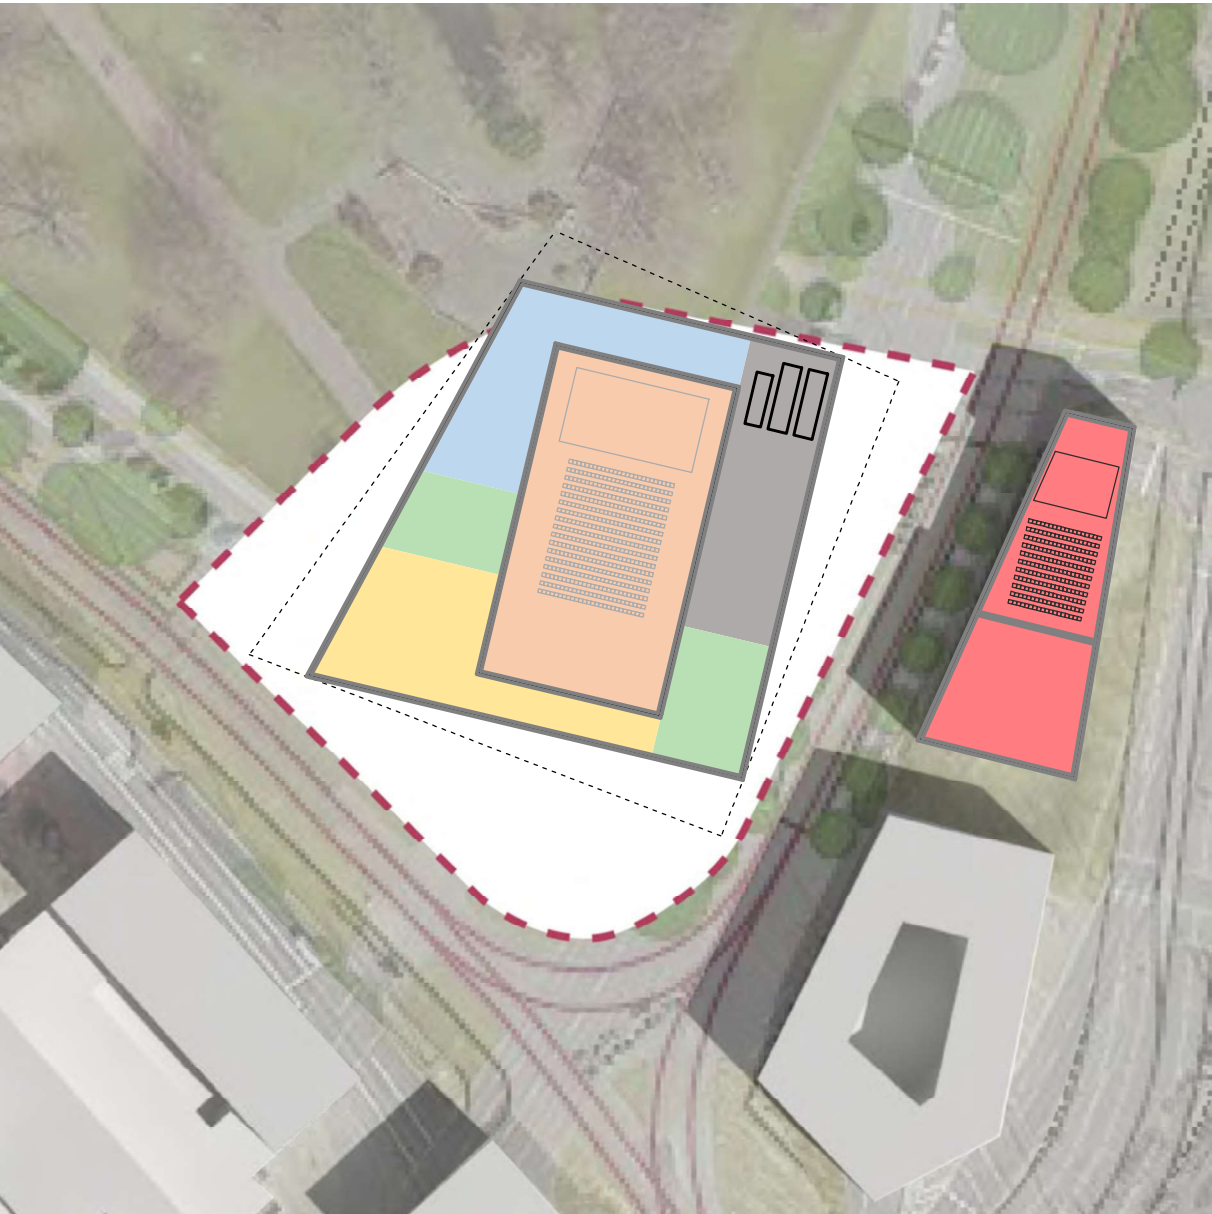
Grundriss EG Bahnhofsquartier V2
